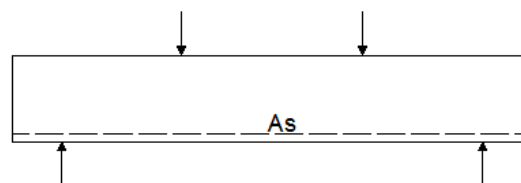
1 Viga de hormigón armado sometida a la acción de varias cargas.
